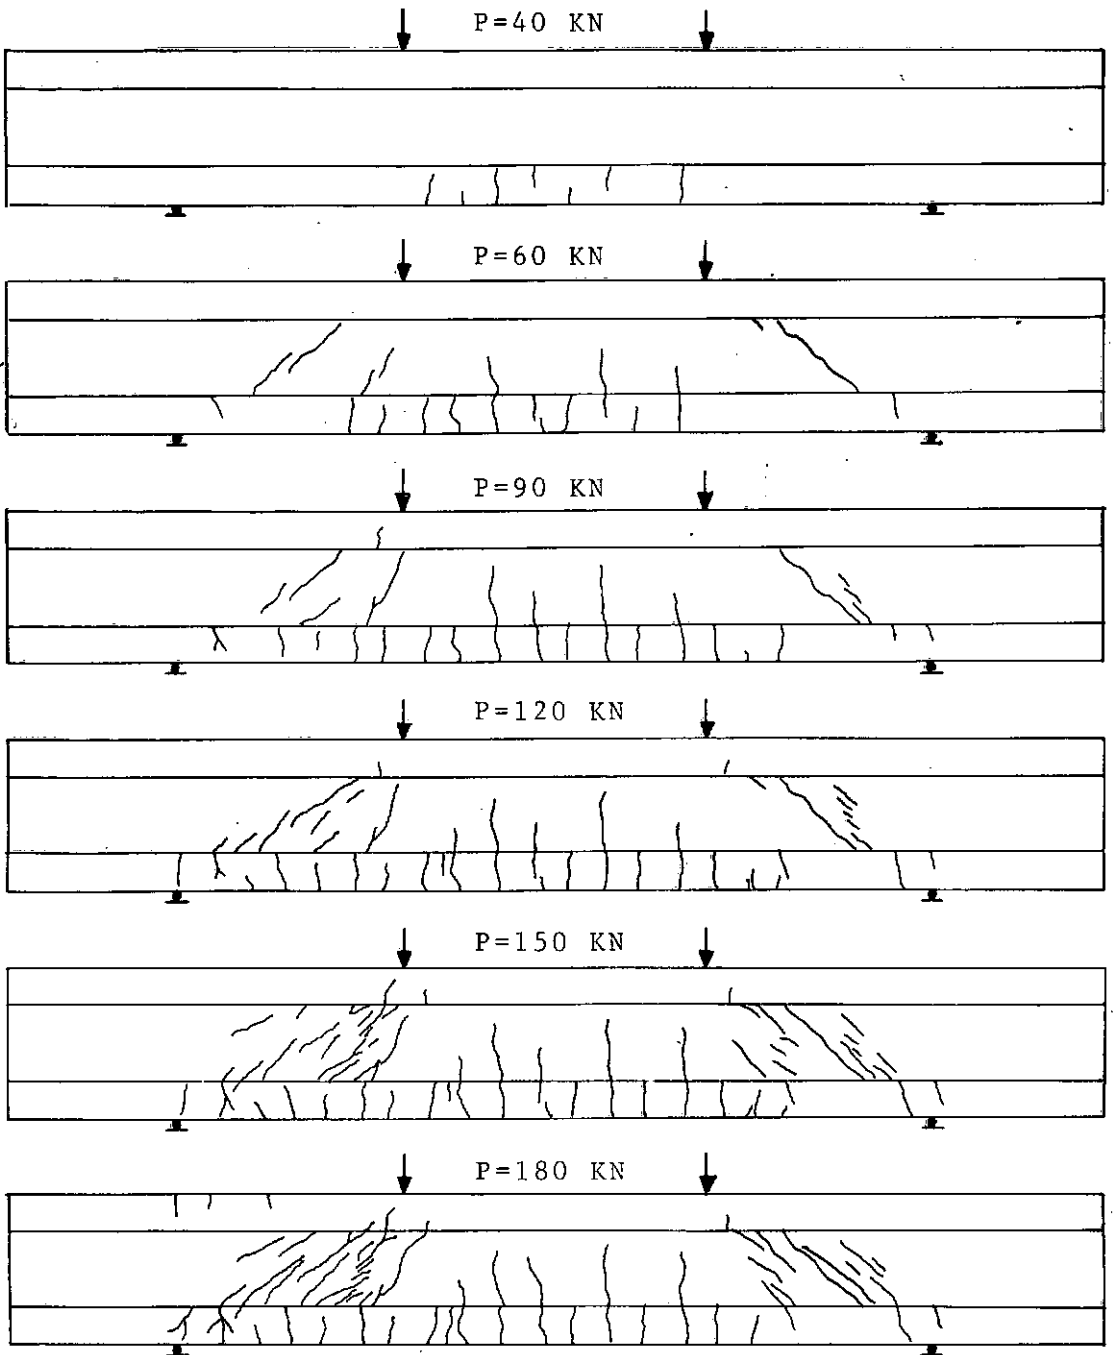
Fissuração da V14-3,70-SI
